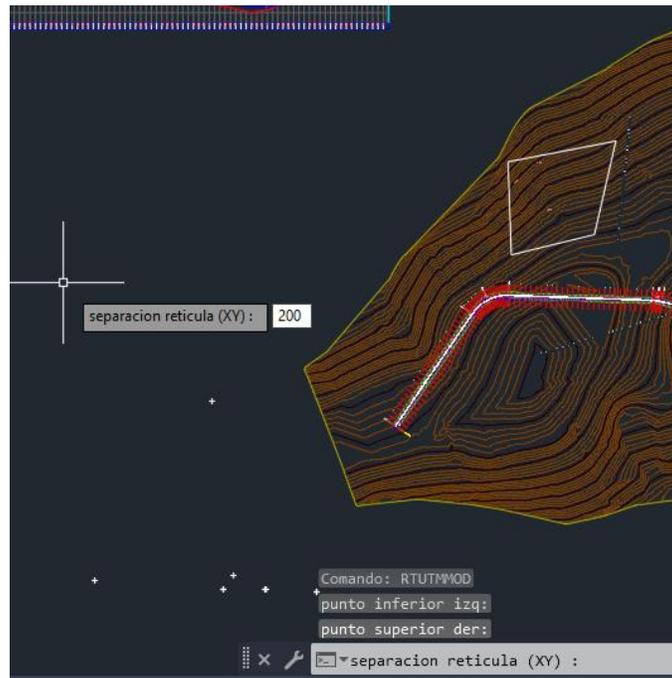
Indicación de la separación entre ejes verticales y horizontales
